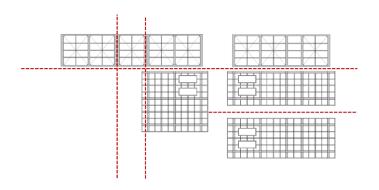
(d) Denah Pembalokan Lantai 2
